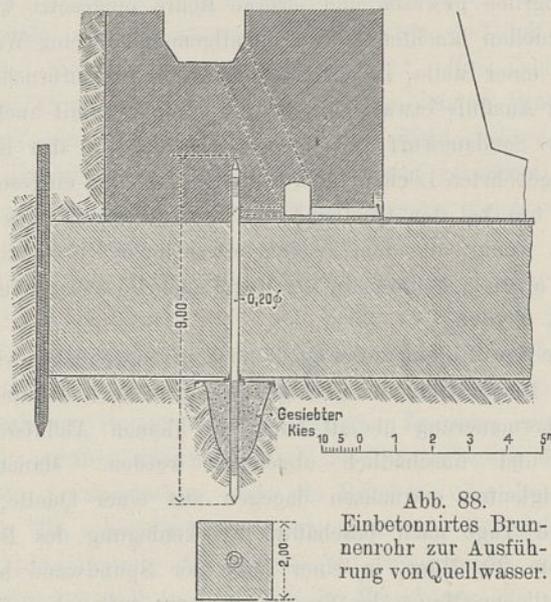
Einbetonirtes Brunnenrohr zur Ausführung von Quellwasser.
